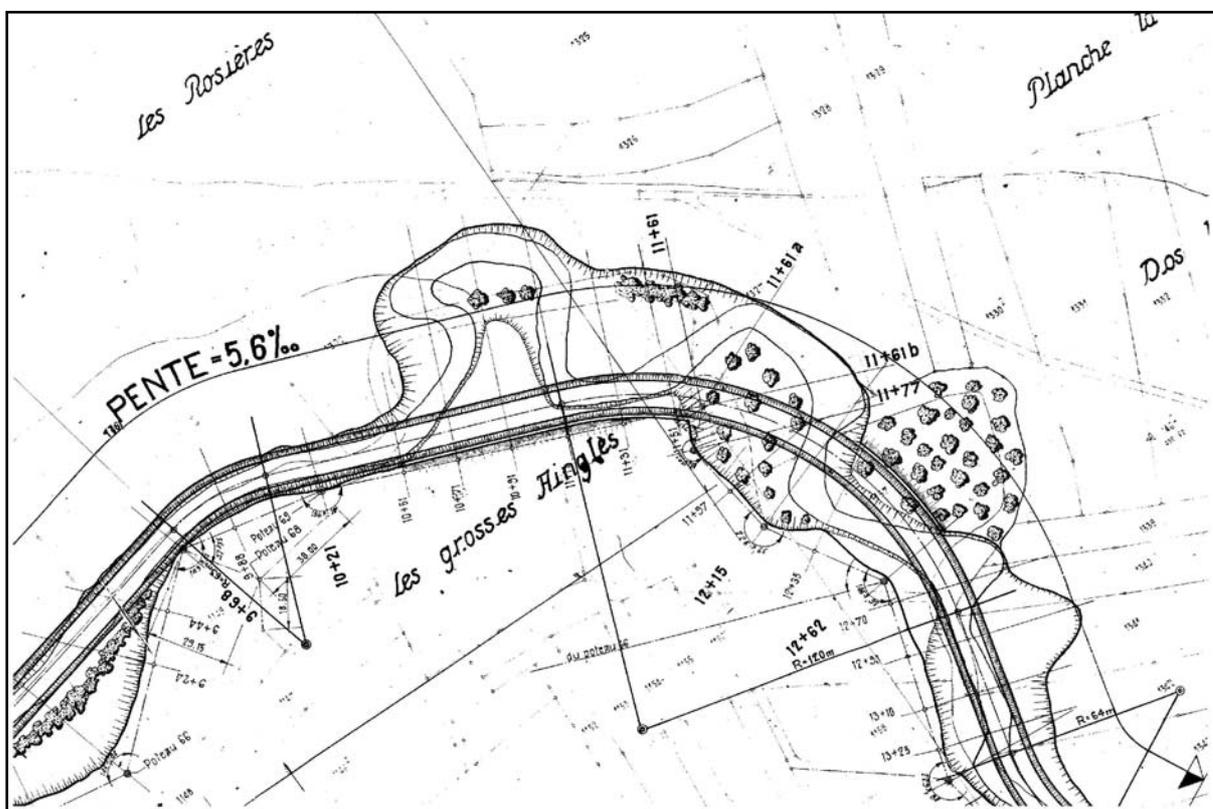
Extrait d'un plan de correction de la Sorne sur la commune de Courfaivre vers 1960. On distingue les anciens méandres et le tracé de la correction aux allures routières.
